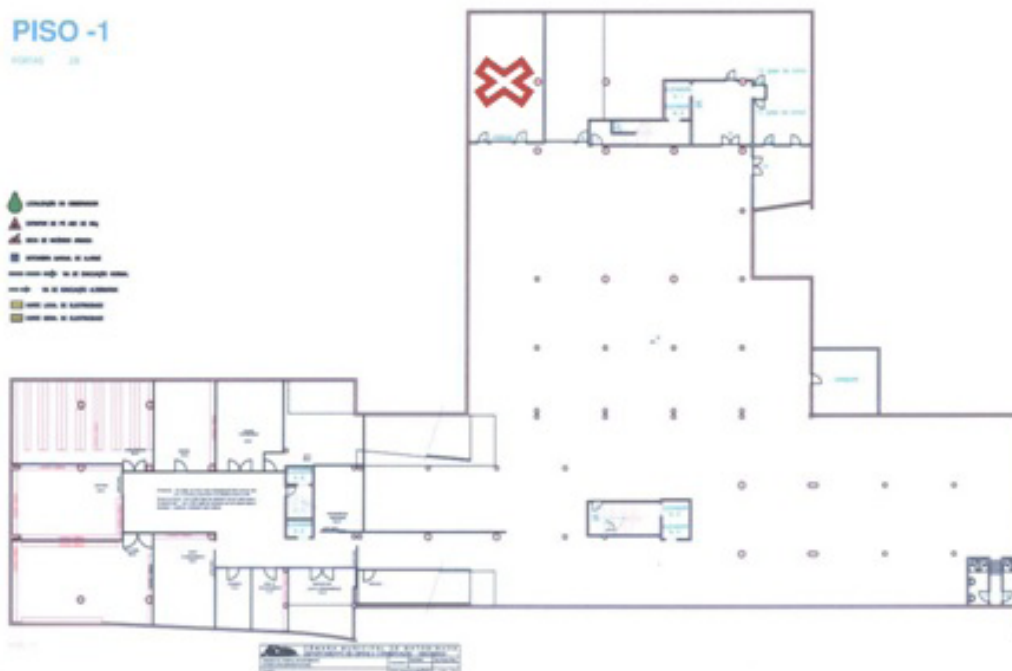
Planta do Piso -1 do edifício da C.M.M., Área da reserva assinalada. Planta gentilmente cedida pela C.M.M.
